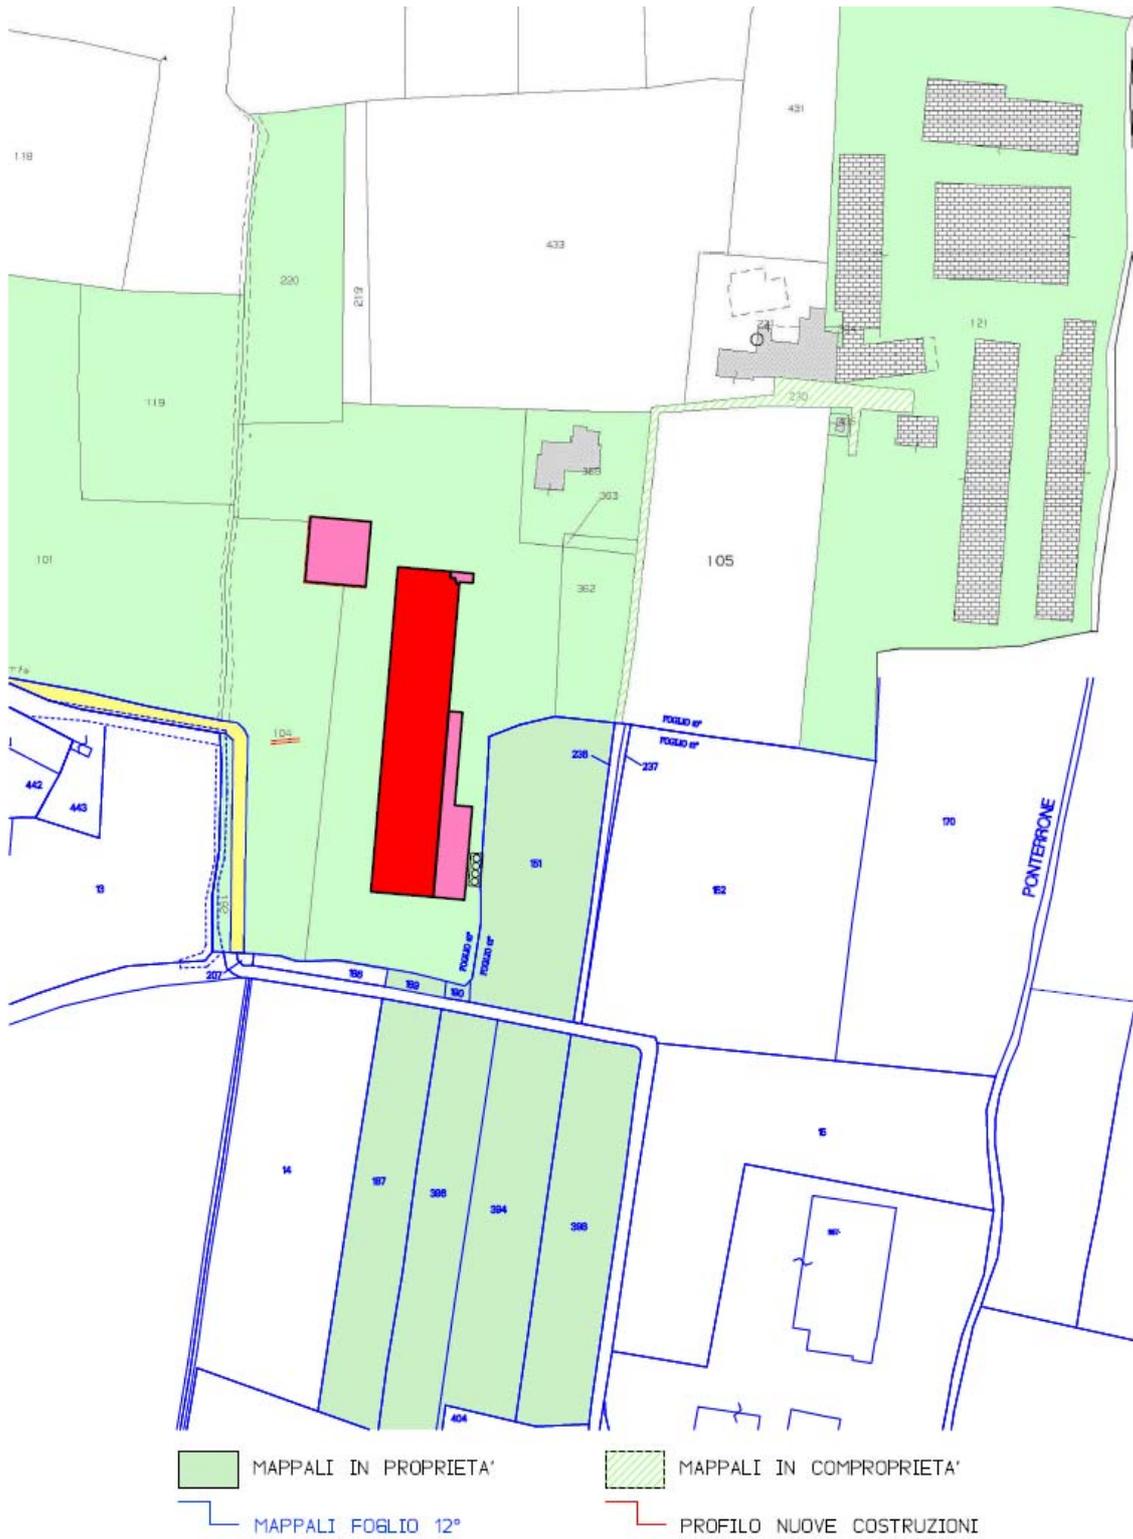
stralcio estratto di mappa scala 1:2000 con inserimento piante interventi in progetto
